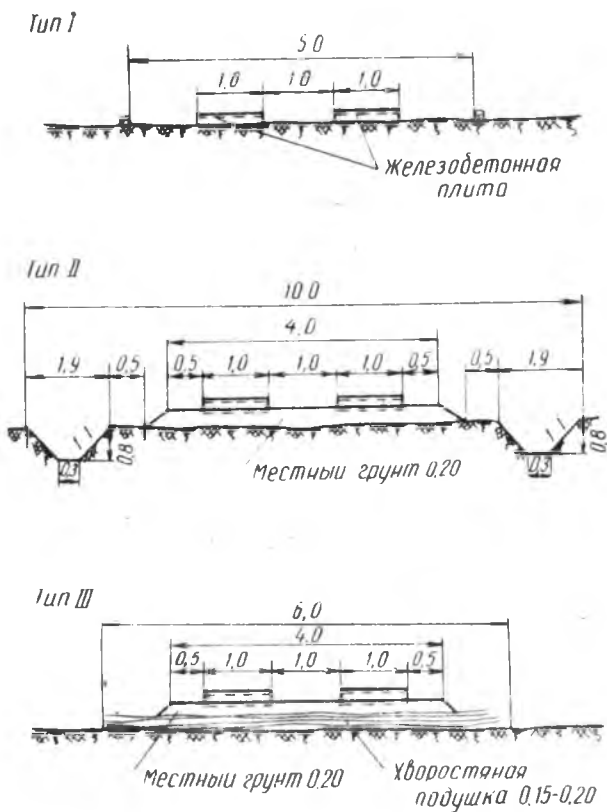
Поперечные профили уса с колесопроводами из железобетонных плит (и деревянных щитов)
